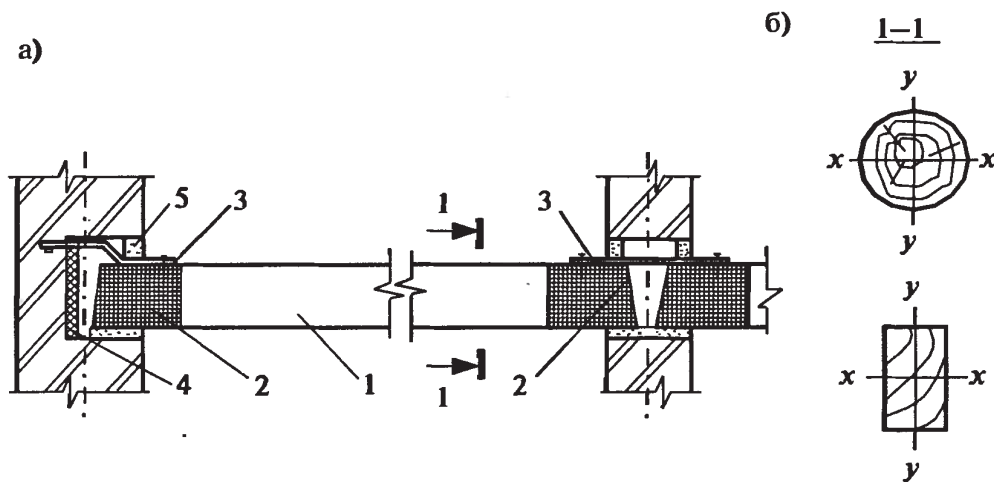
Розміщення дерев'яної балки перекриття з масивної деревини у цегляній стіні, де: а – обпирання масивної балки на стіні; б – перетини балок; 1 – балка; 2 – шари толю; 3 – сталевий анкер; 4 – теплоізоляція; 5 – цементно-піщаний розчин [3]
